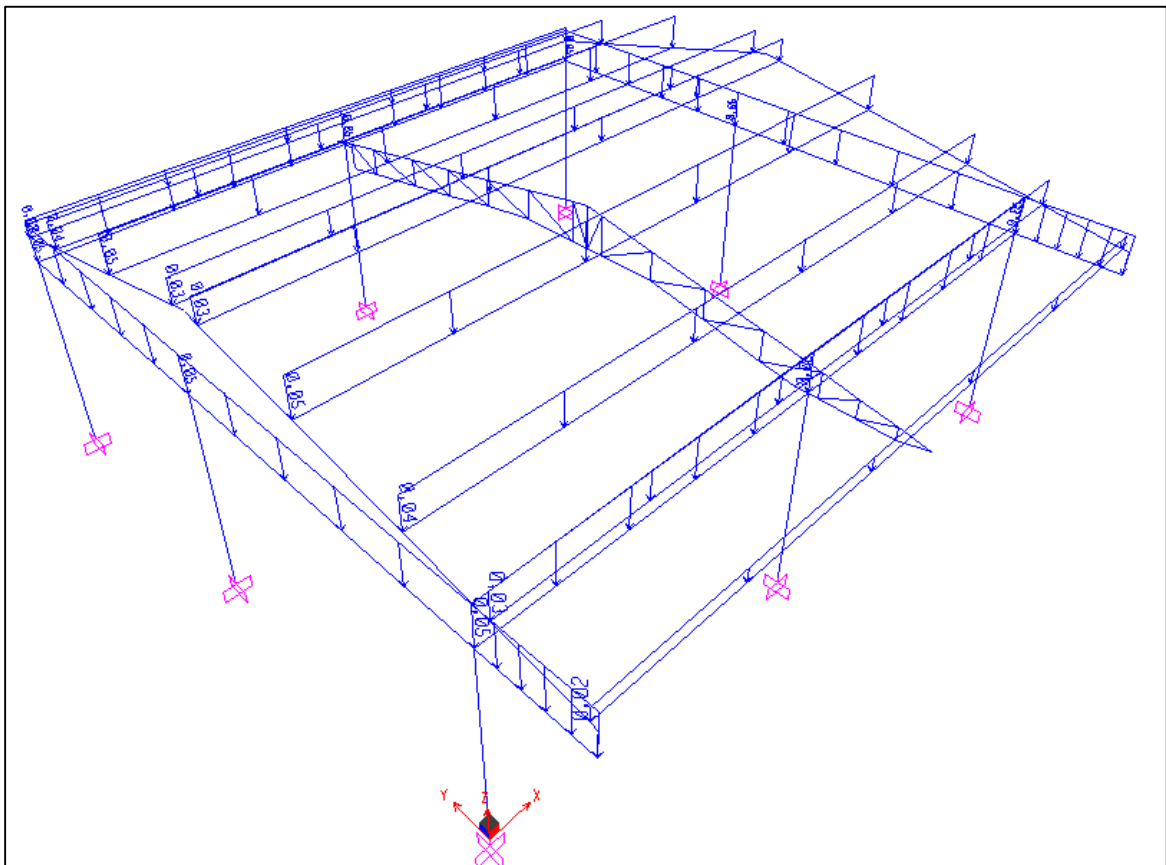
Disposición de cargas sobre la estructura.
